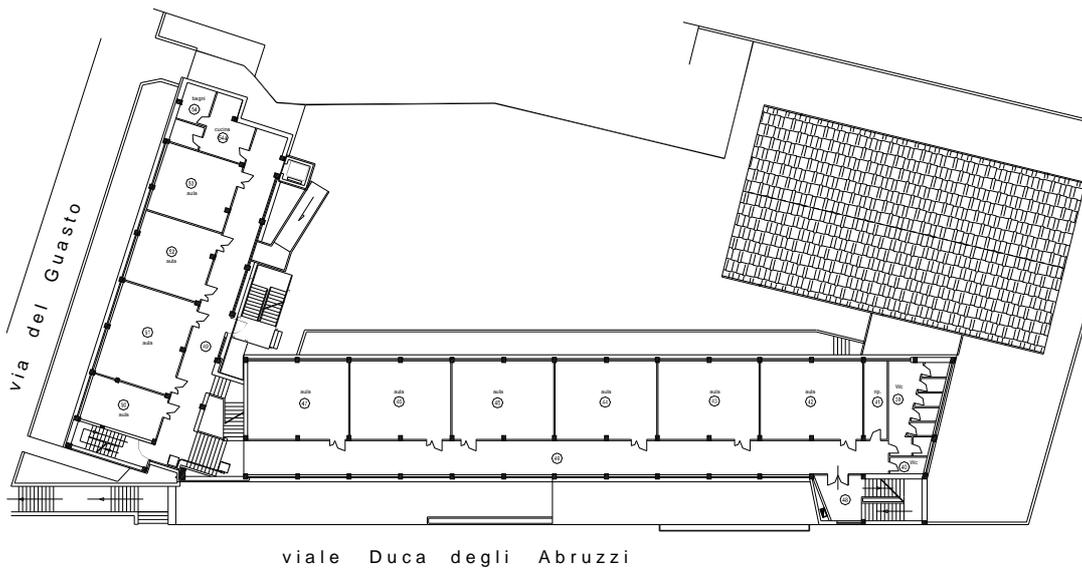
Pianta Piano Secondo (aule scolastiche).
